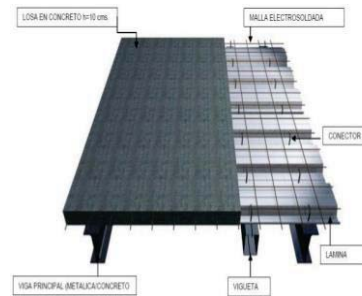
Sistema losacero. Fuente: www.galvadeck.com.mx
